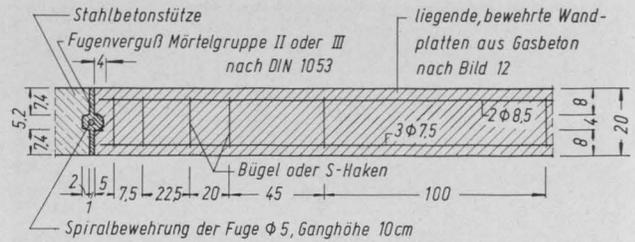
Bewehrung und seitlicher Anschluß einer Gasbetonbrandwand (vgl. auch mit Bild 5, Anschluß 8)
